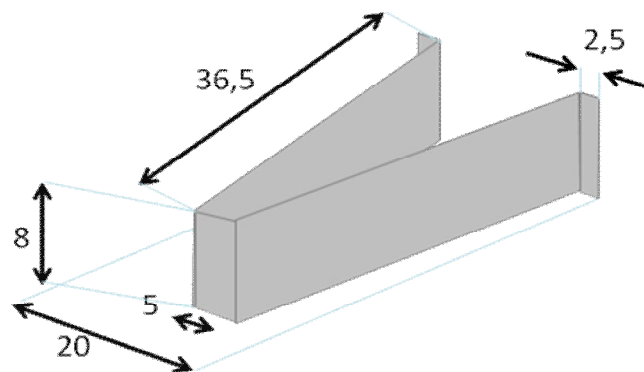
Vista de las dimensiones dadas a un ciclo de vertedero.
